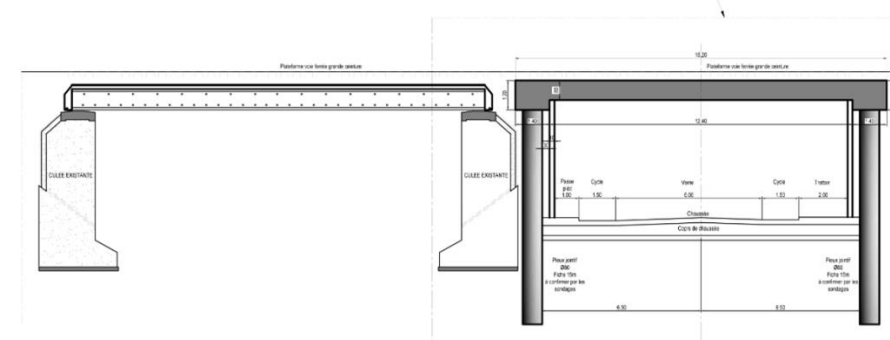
Modification de l'ouvrage sous la RD 190 (vue en coupe de l'ouvrage existant à gauche et de l'ouvrage en projet à droite)
